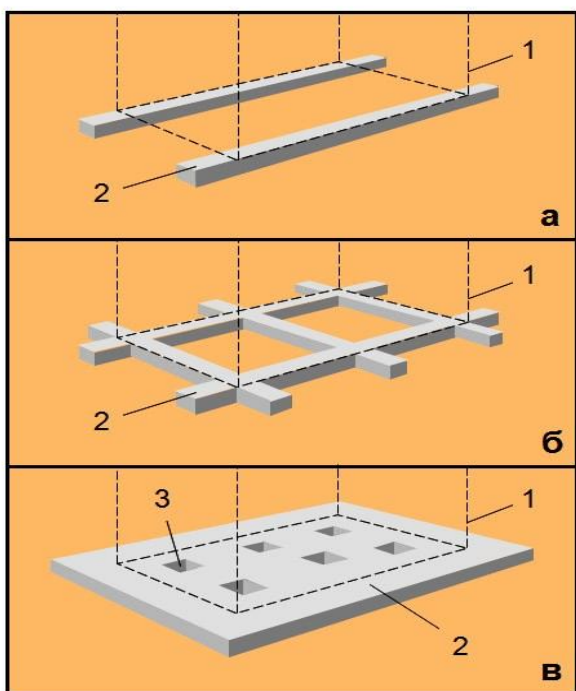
Рекомендуемые к применению типы монолитных железобетонных фундаментов, защищающих здания от провалов: а) ленты; б) перекрестные ленты; в) плита; 1 – контуры здания; 2 – консольные выпуски фундамента; 3 – сквозные отверстия, предназначенные для оперативной ликвидации провала.
